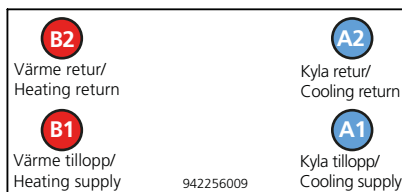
Wasseranschluss – Länge 600, 1200 und 1800\
